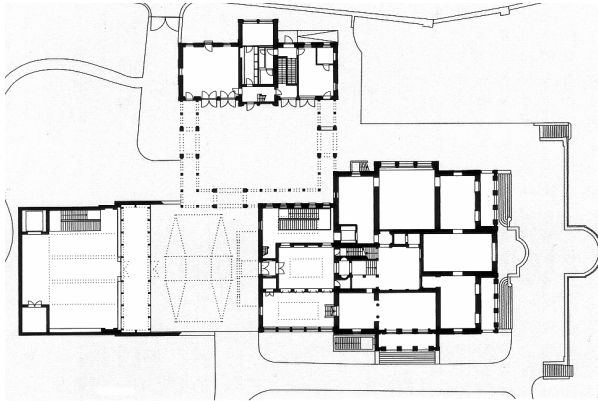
Museum Rietberg, Grundriss EG, Veranschaulichung des Ensemblecharakters der drei architektonischen Elemente.
